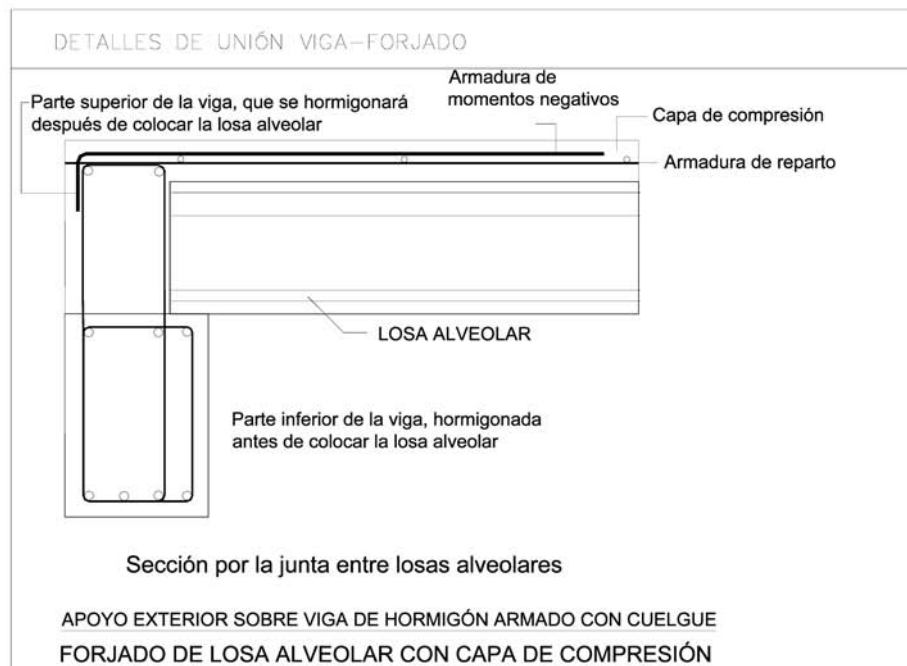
Secciones L y T en vigas para apoyo de losas alveolares.
